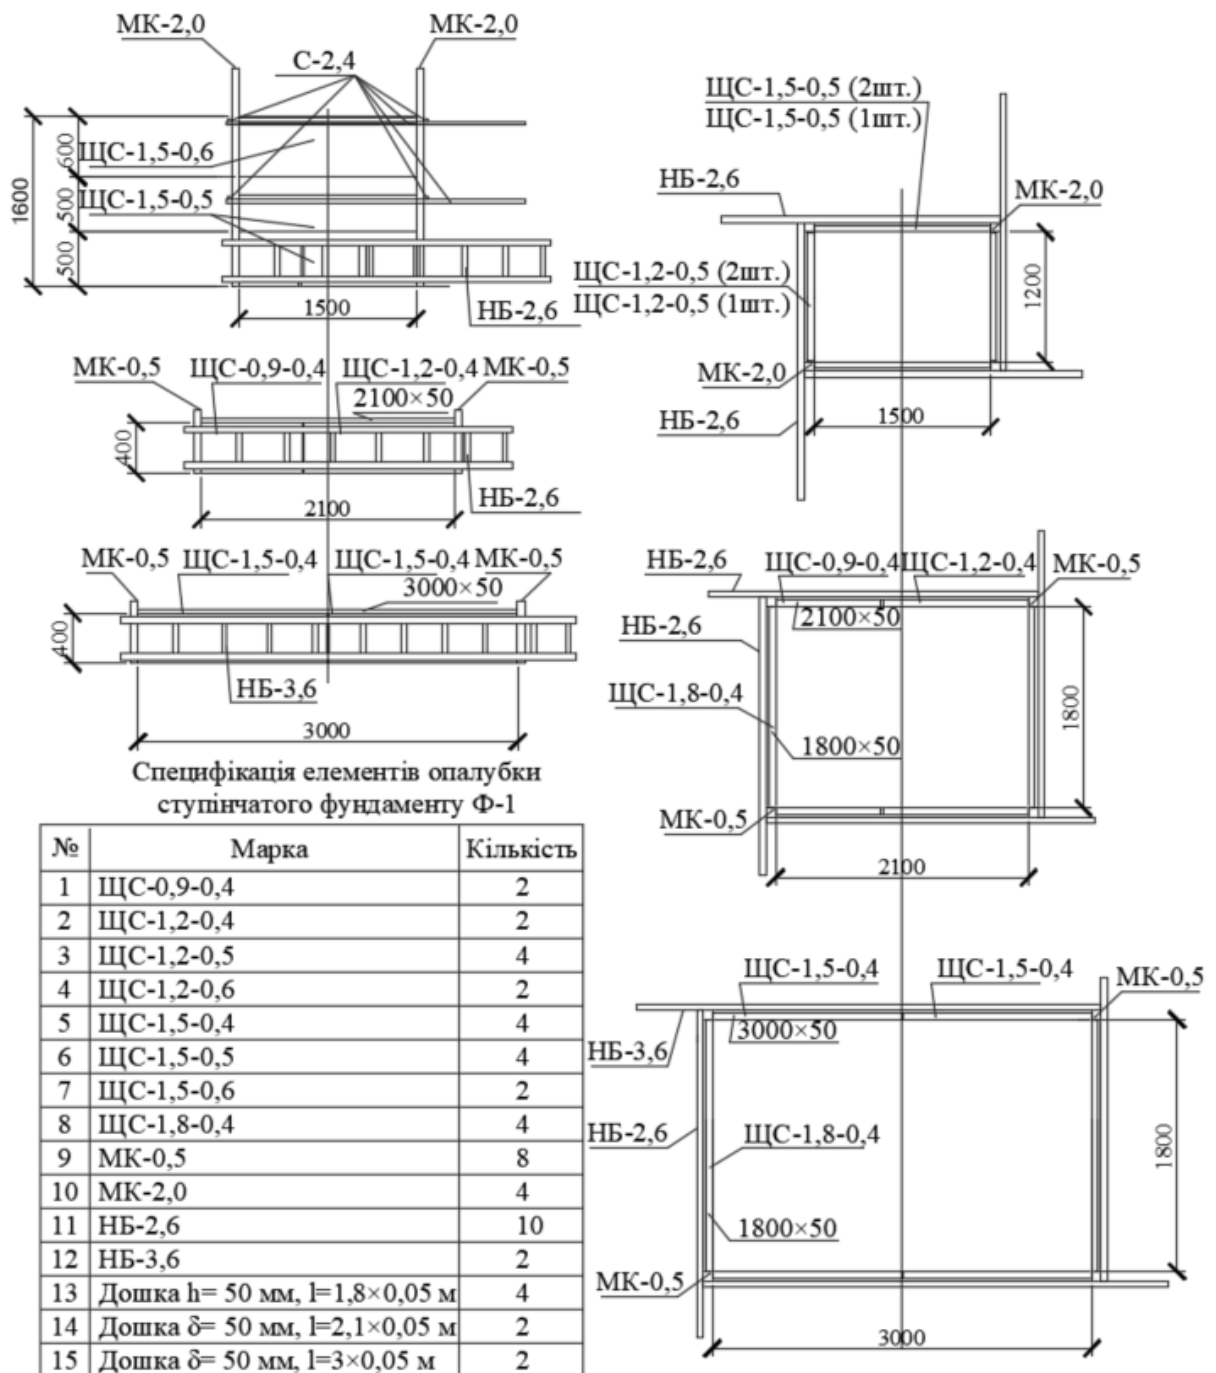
Маркувальна схема ступінчатого фундаменту зі специфікацією елементів опалубки
